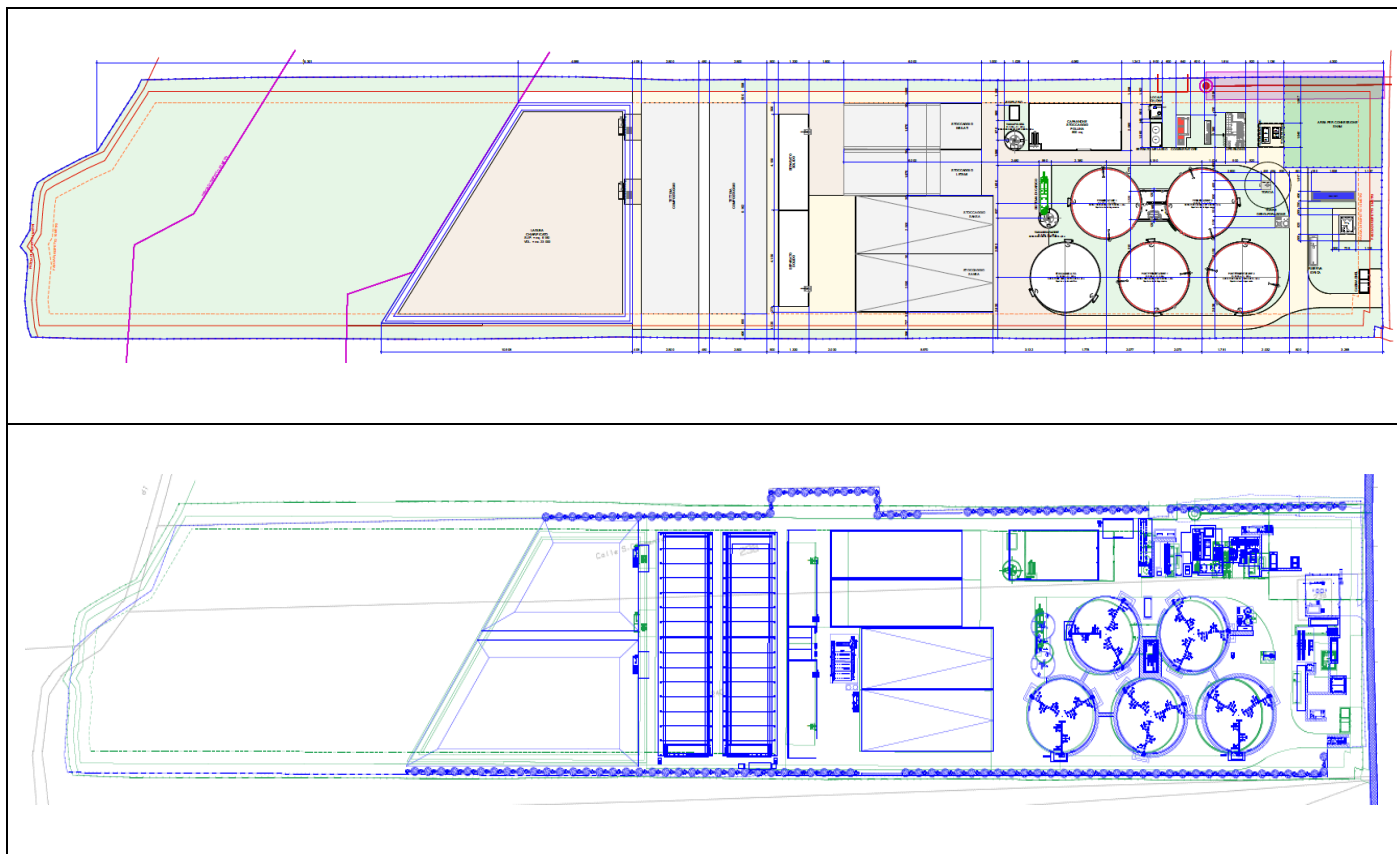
Planimetria autorizzata in alto. Planimetria comparativa in basso.
